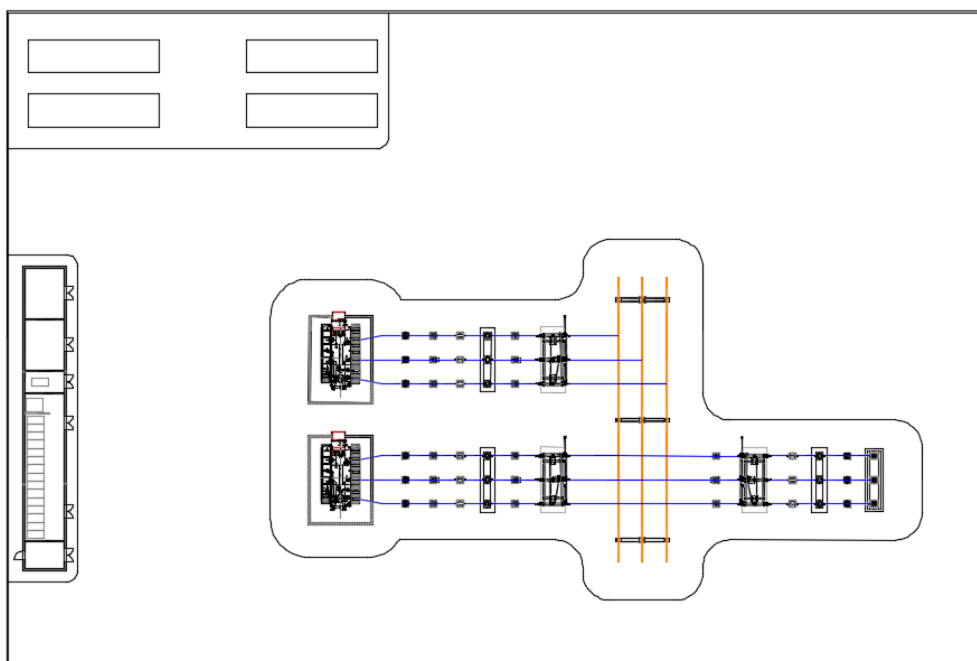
Sottostazione elettrica di utente (SEU) del Proponente. Planimetria
